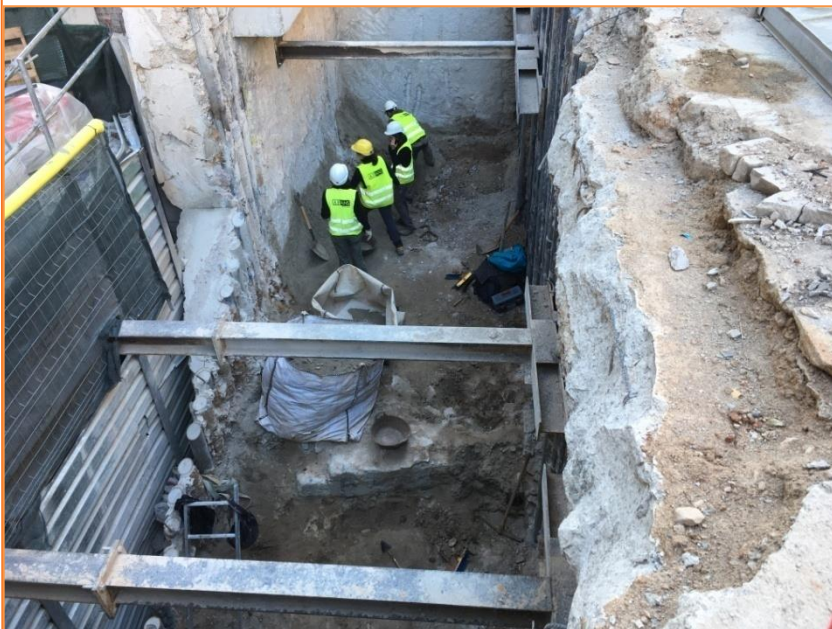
Vista dels treballs de neteja de la darrera campanya d'excavació.
